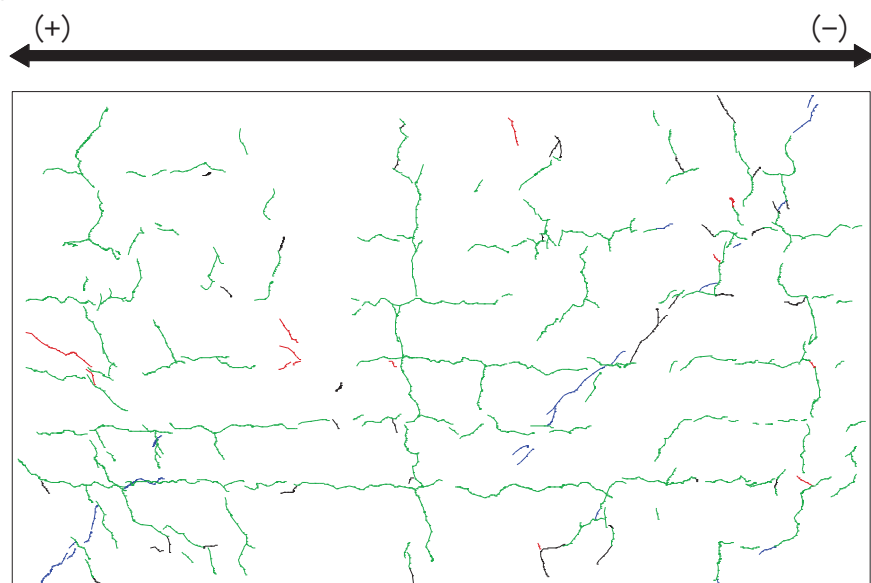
(4) 乾燥試験体 [2] 1/3333rad. におけるひび割れ図
